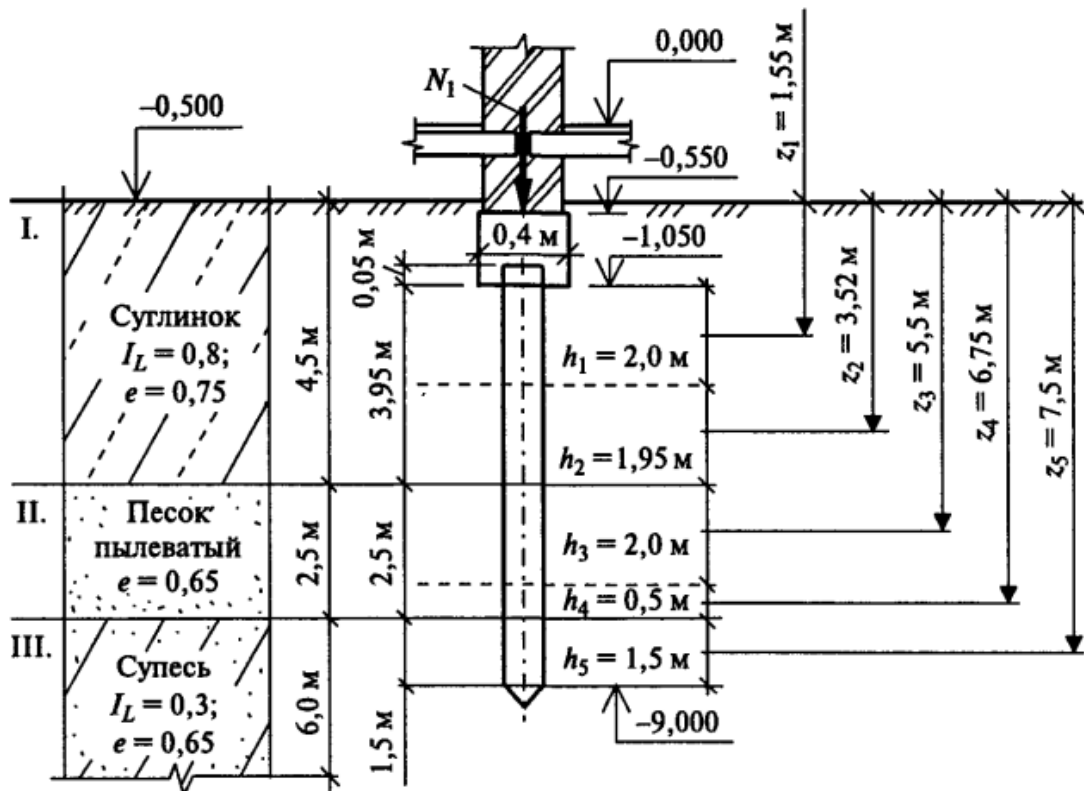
Грунтовые условия, размеры ростверка — к примеру 12.7
